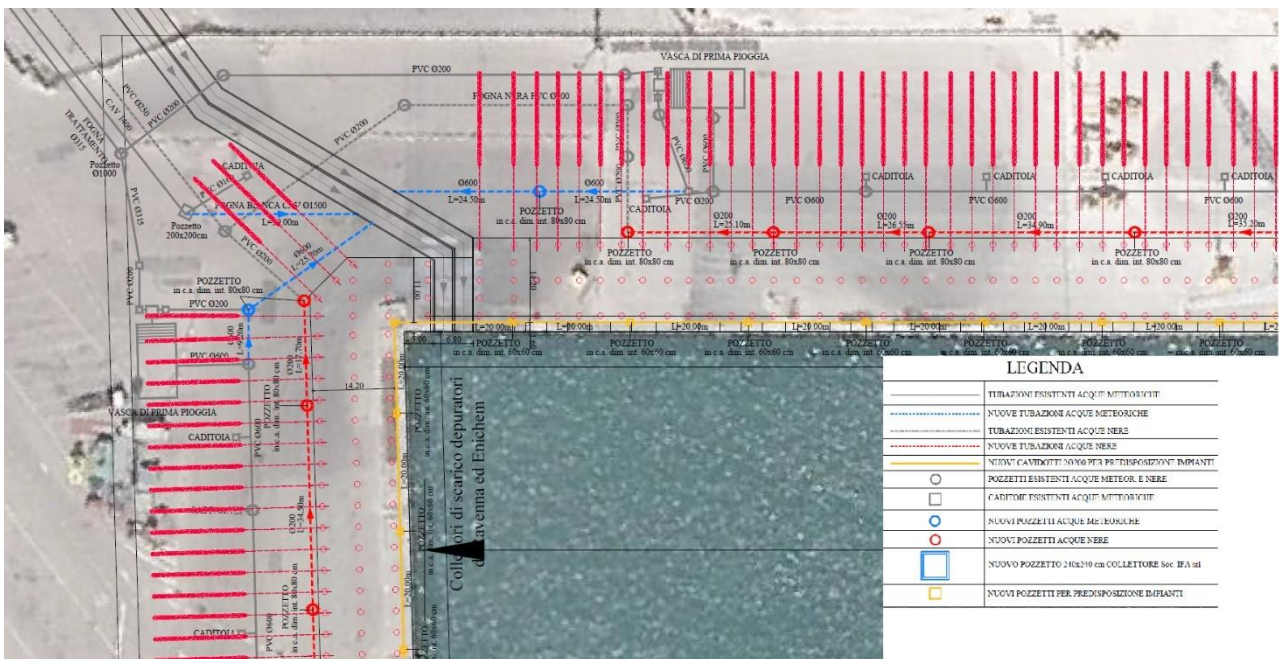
Stralcio planimetrico interventi di progetto definitivo
